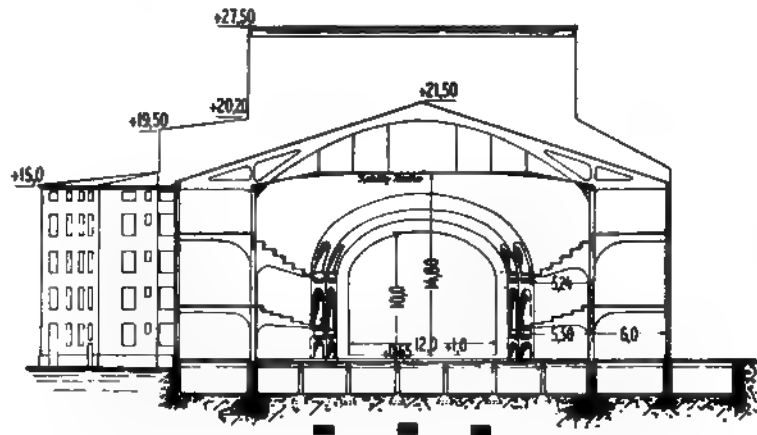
Querschnitt des Metropoltheaters in Breslau.
